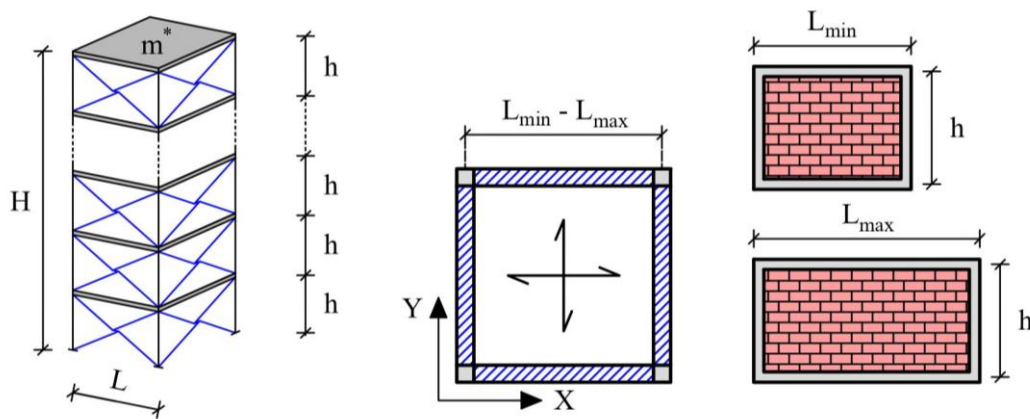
Layout della generica struttura benchmark 3D in c.a. con tamponature.
